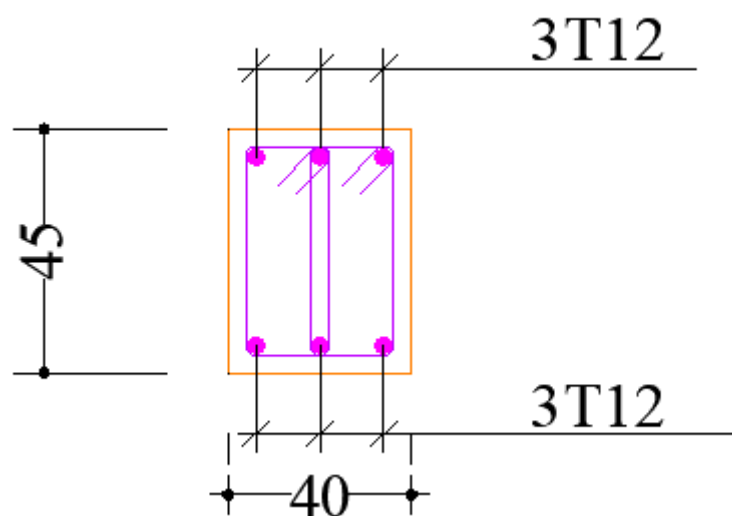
Ferrailage de la poutre palière en appui et en travée
